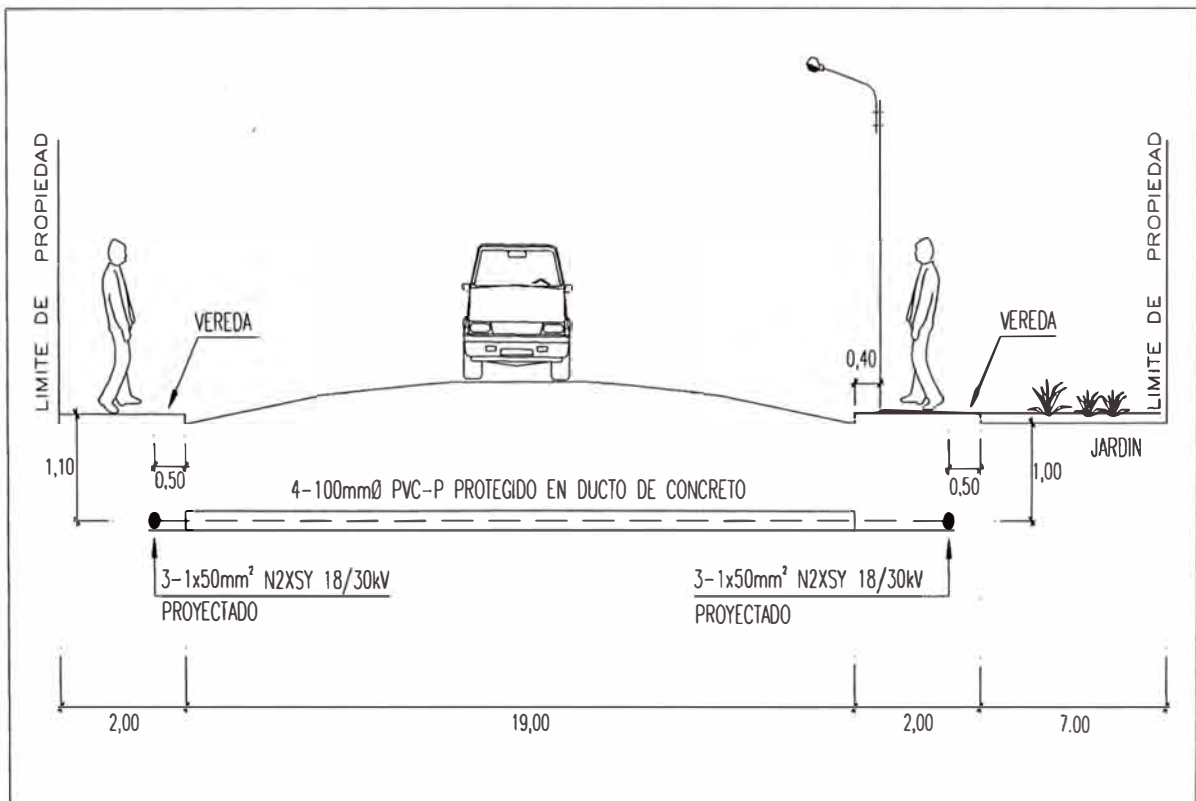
Detalle de instalación de cable bajo pista (corte 2-2).
